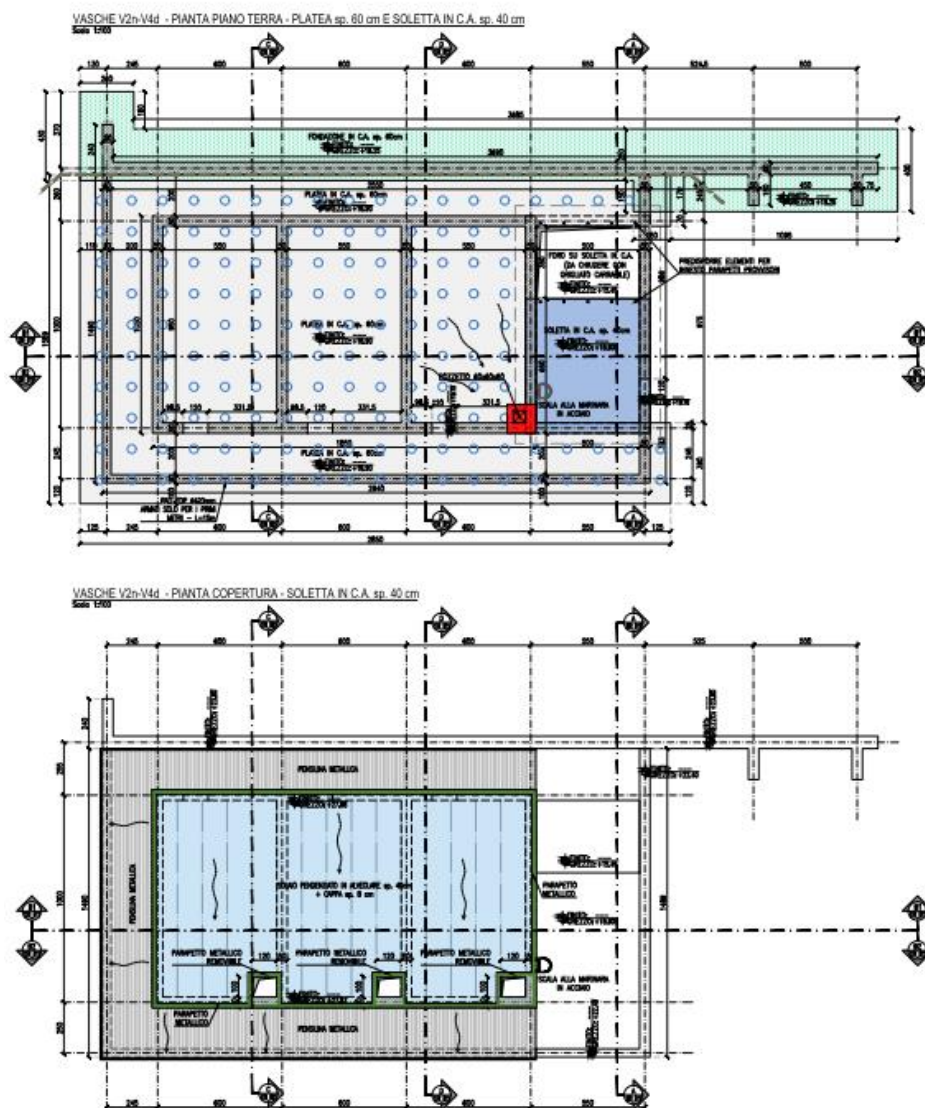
Pianta fondazioni Vasche V4d-V2n
